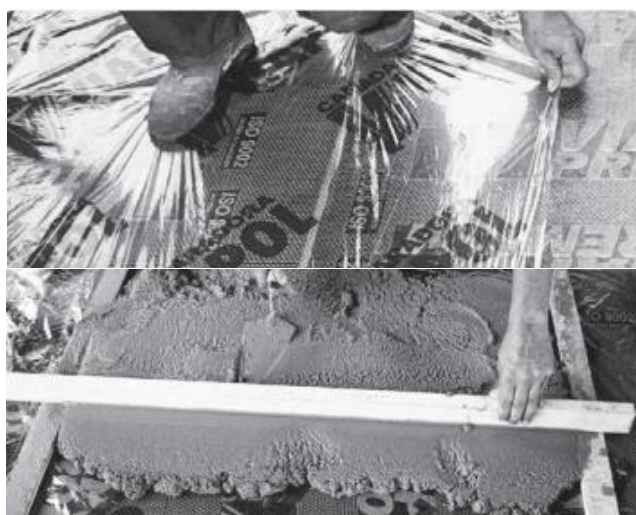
Aplicação da camada separadora e da proteção mecânica em argamassa.
